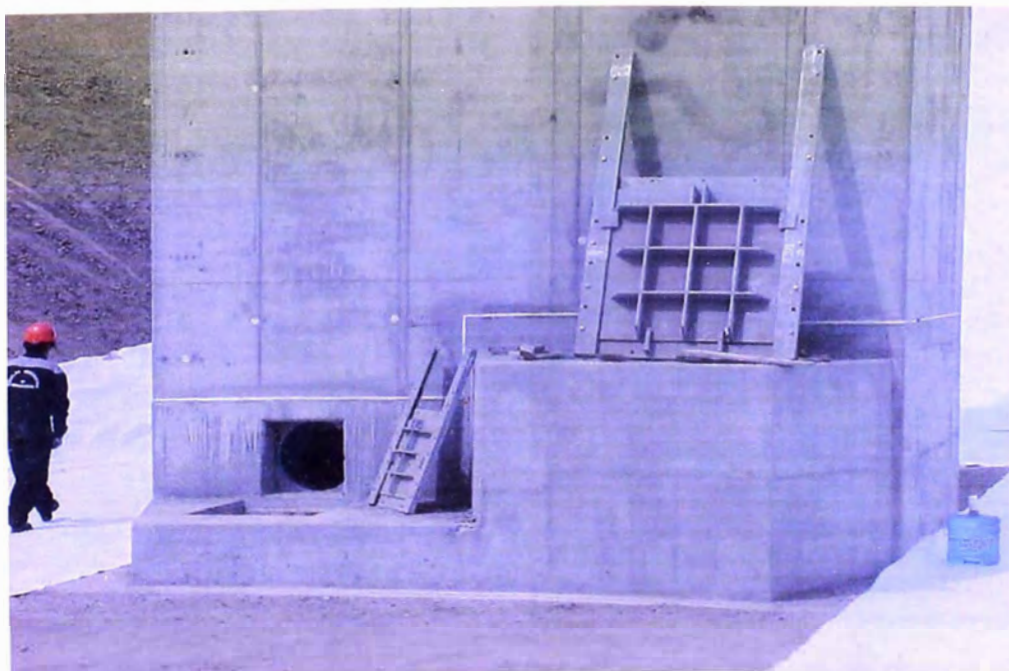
Estructura de salida, compuertas planas de accionamiento manual por su montaje, idem foto anterior con mas detalle.
